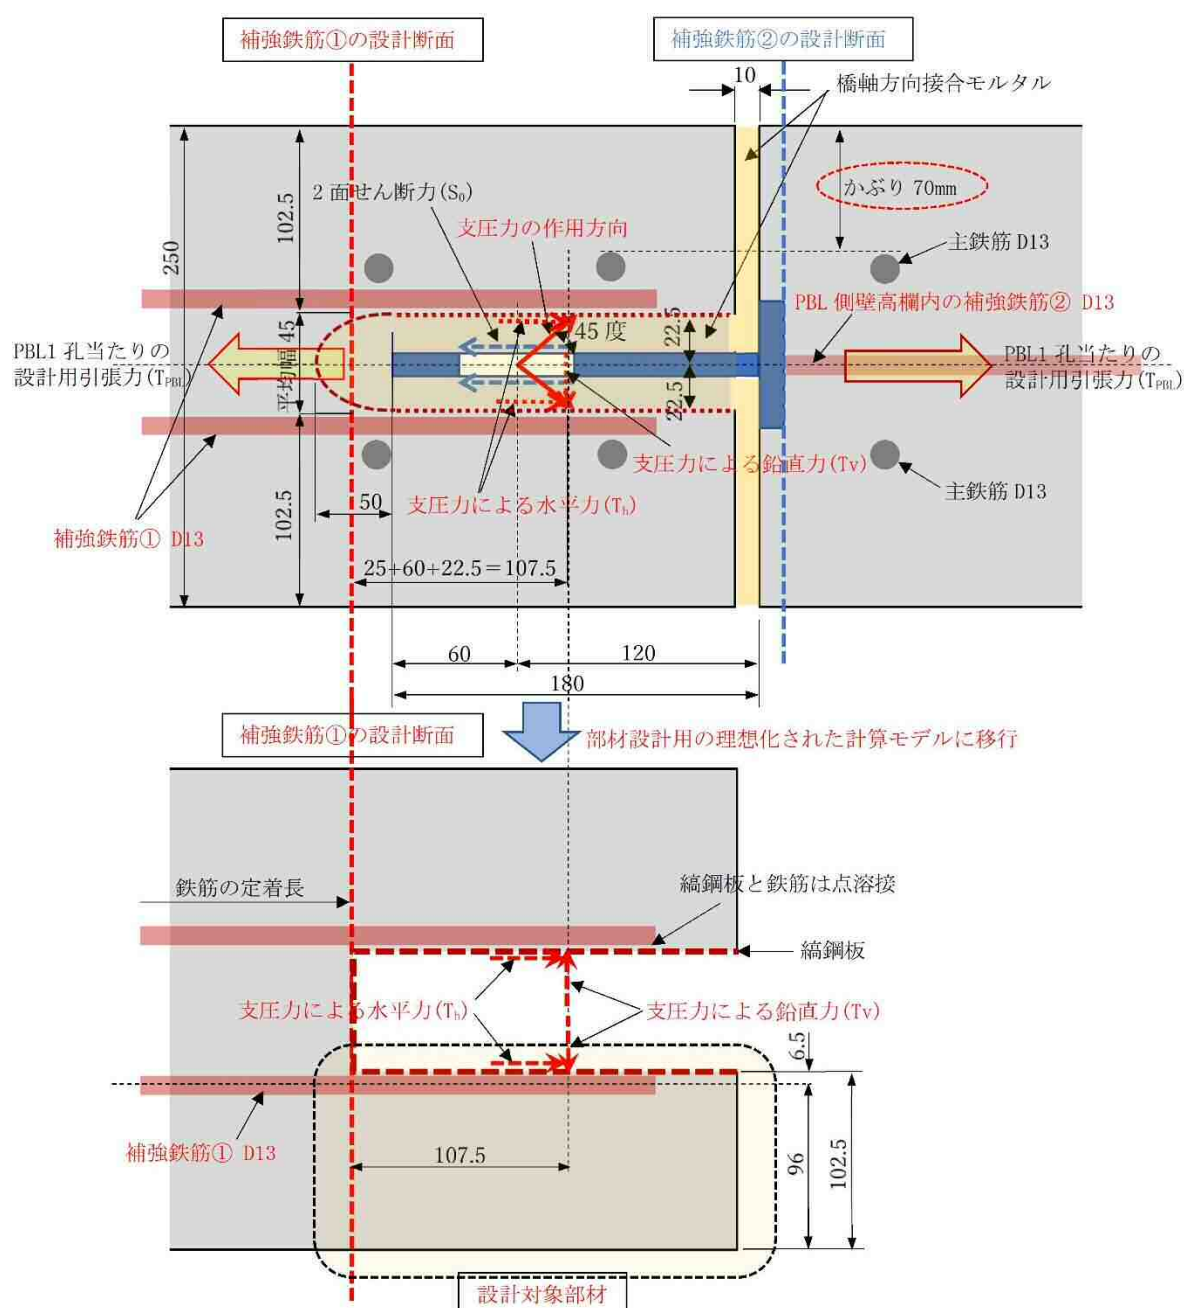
設計対象とする補強鉄筋の設計上の配置と設計対象部材
